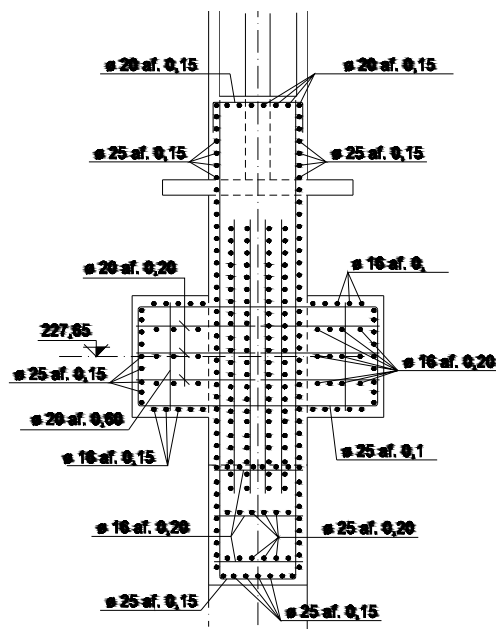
Pilar PE3 - Armaduras –Corte H-H
